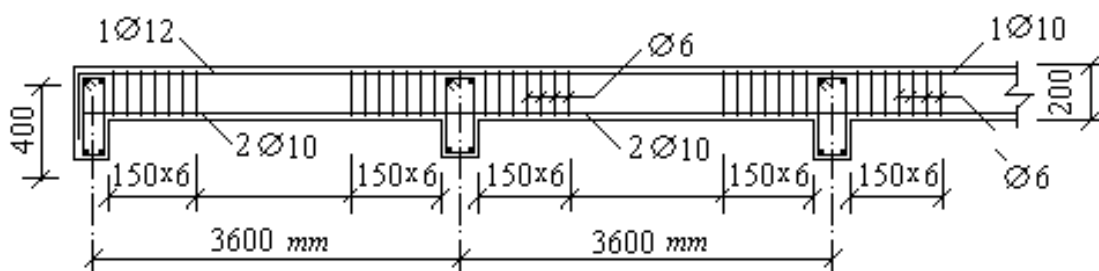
Ferrailage des poutrelles du plancher des balcons
